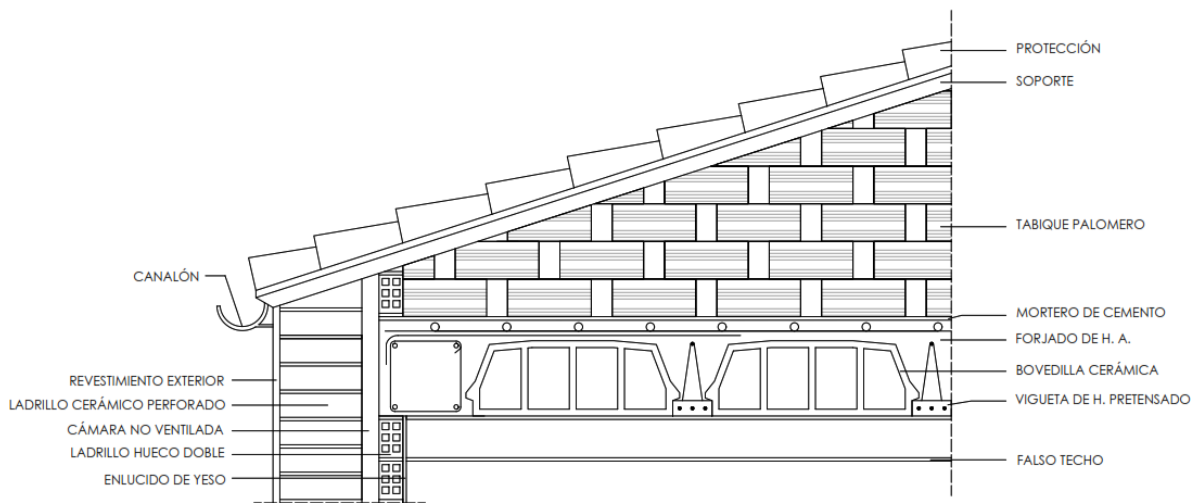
Detalle constructivo vivienda 969, estado reformado.
